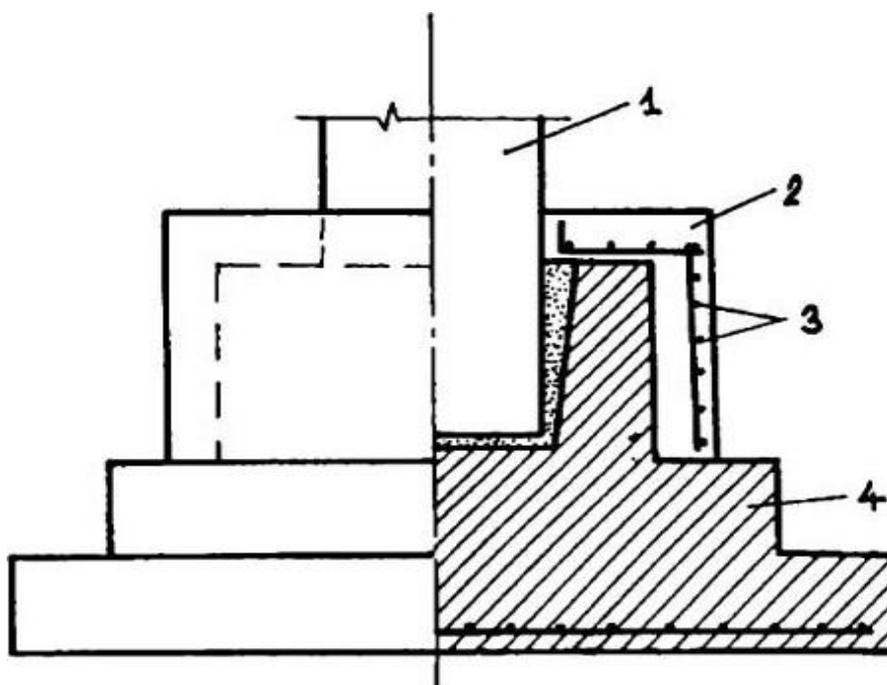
Схема усиления фундамента под колонну железобетонной обоймой без увеличения площади подошвы фундамента: 1 – колонна; 2 – обойма; 3 – хомуты; 4 – усиливаемый фундамент
